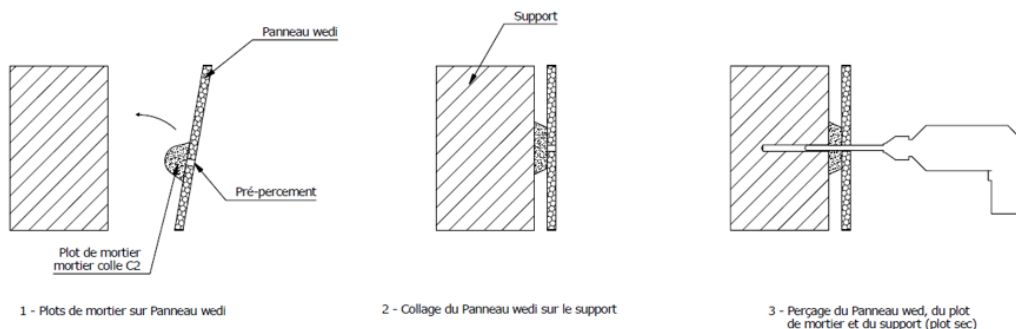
Pose par plots de collage – étanchéité des fixations mécaniques
